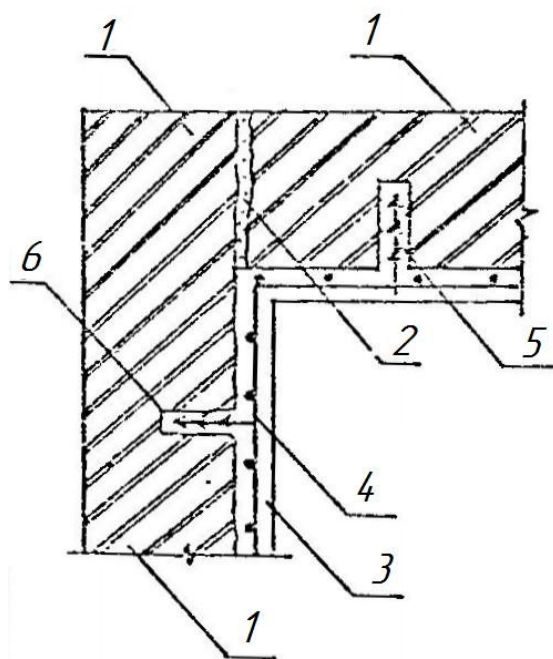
З'єднання кутових зовнішніх стін залізобетонними або штукатурними обоймами: 1 – зовнішні кутові стіни; 2 – тріщина; 3 – штукатурна або залізобетонна обойма; 4 – арматурна сітка; 5 – анкери з арматури; 6 – отвори в стіні
